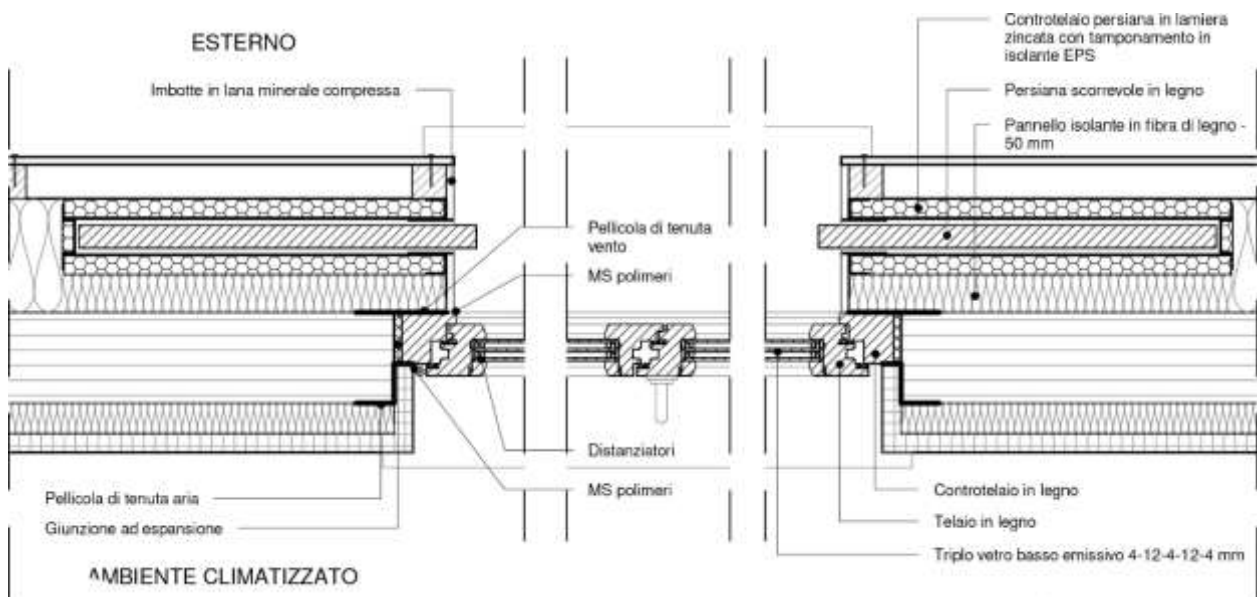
Dettaglio costruttivo della sezione orizzontale della finestra tipo - scala 1:10. [Fonte: elaborazione dell'autore]
